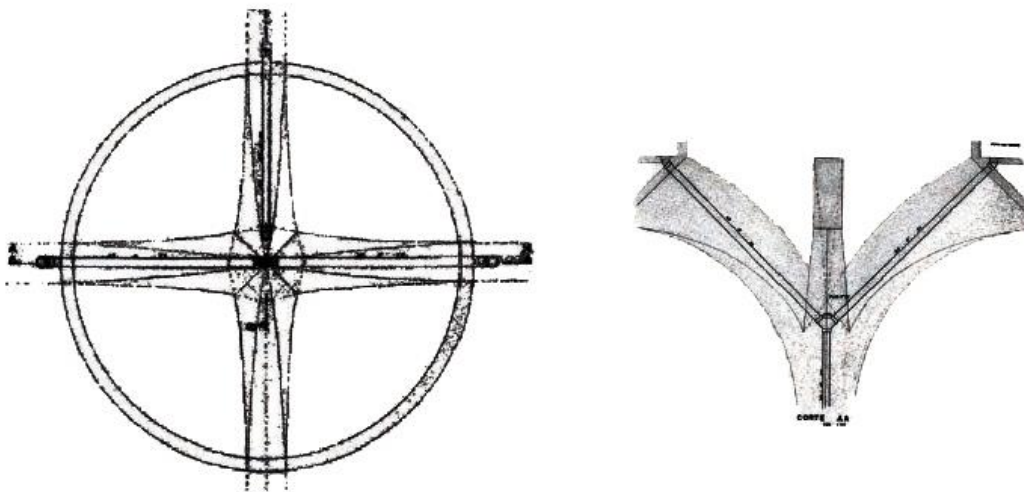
Planta e corte do escoamento pluvial dos pilares da rodoviária de Jaú. Projeto Hidráulico desenvolvido pela empresa Sandretec
